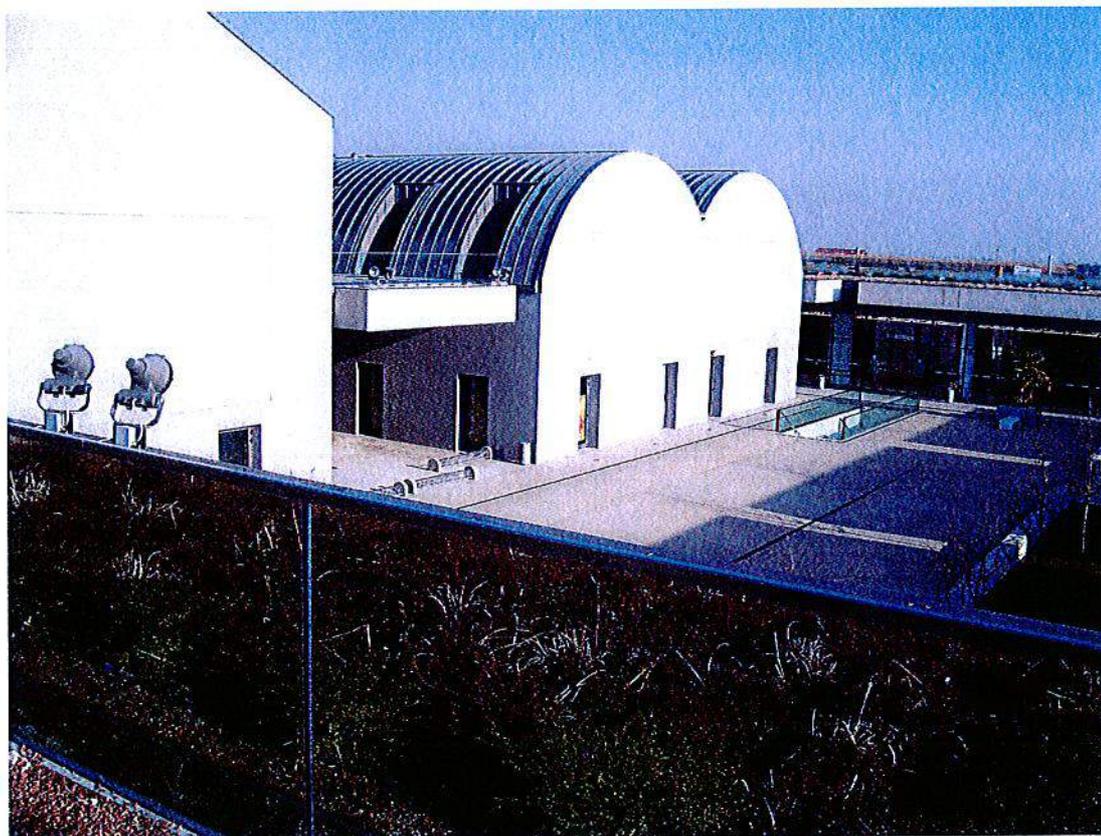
Stato di fatto delle vetrine espositive.
